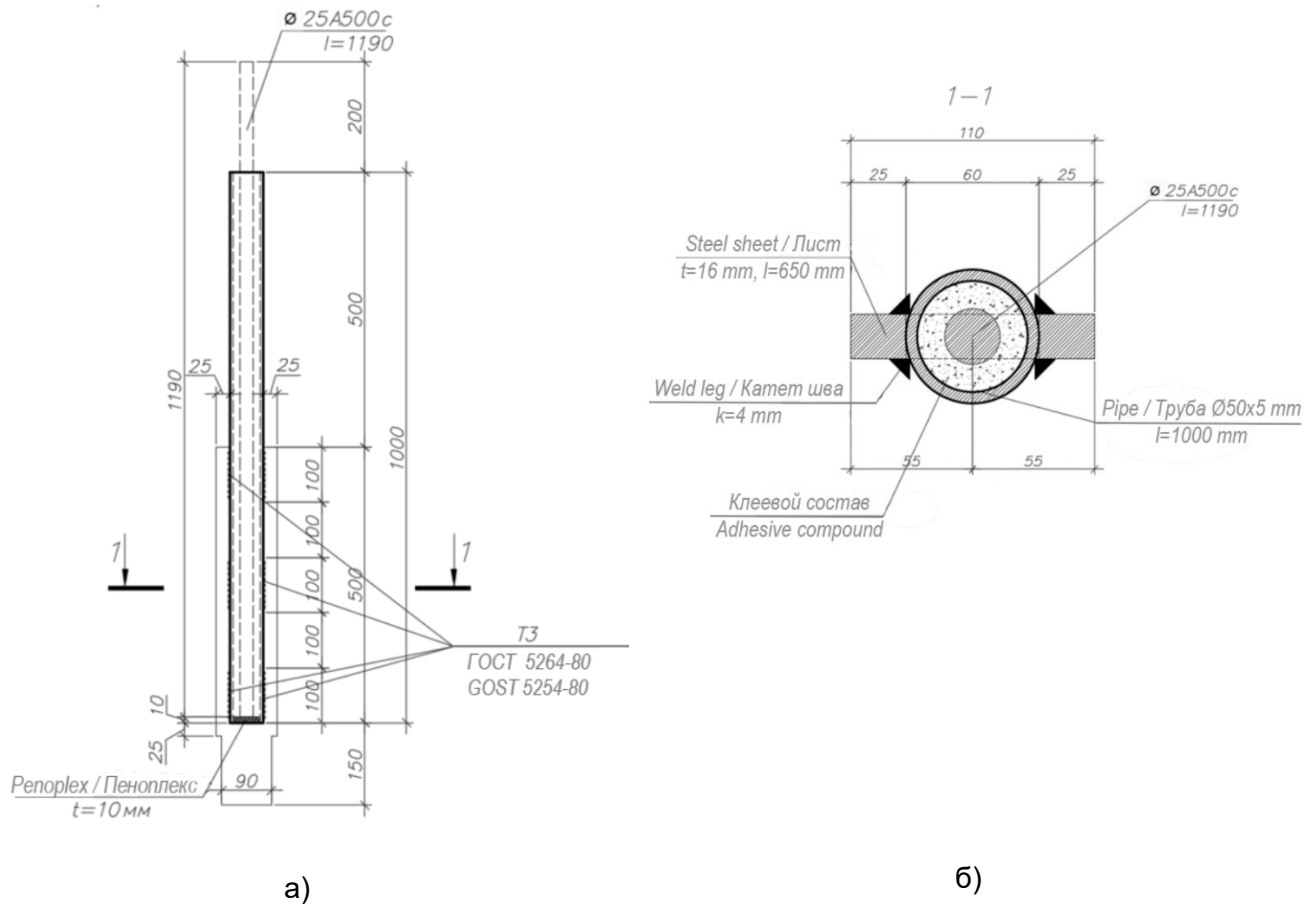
Экспериментальный образец: а – вид спереди; б – вид сверху
